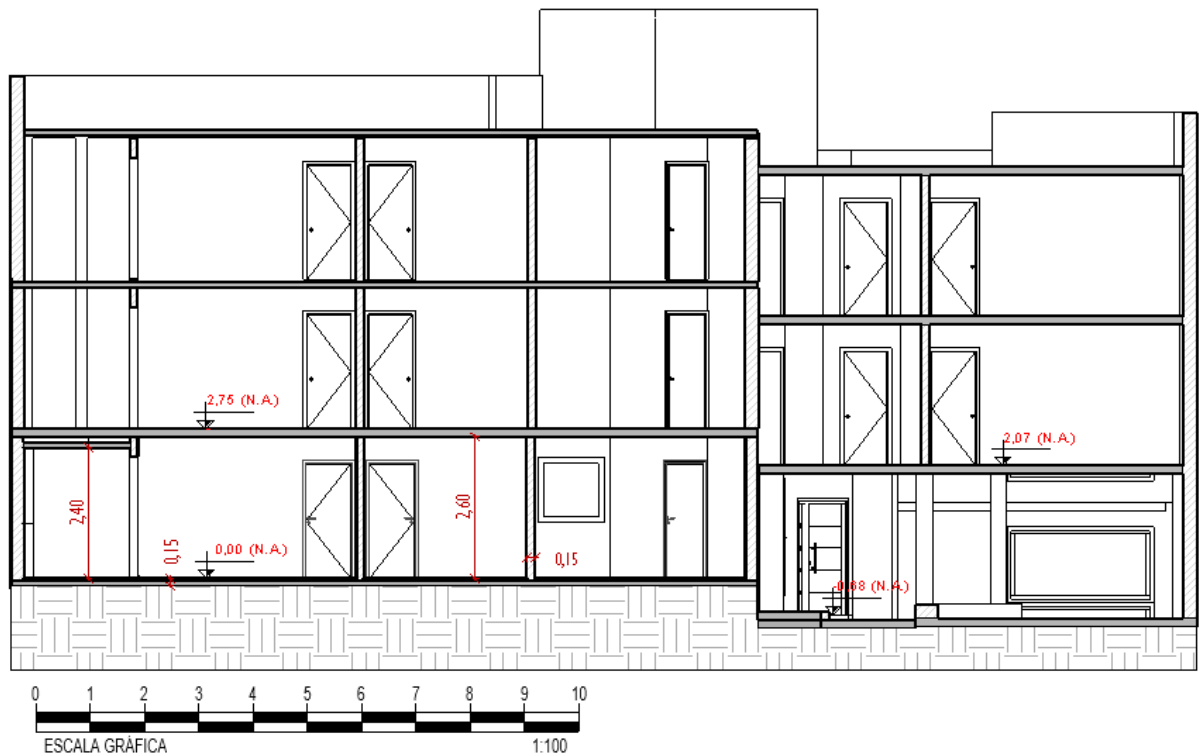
Vista do levantamento genérico do pavimento térreo completo da edificação.
